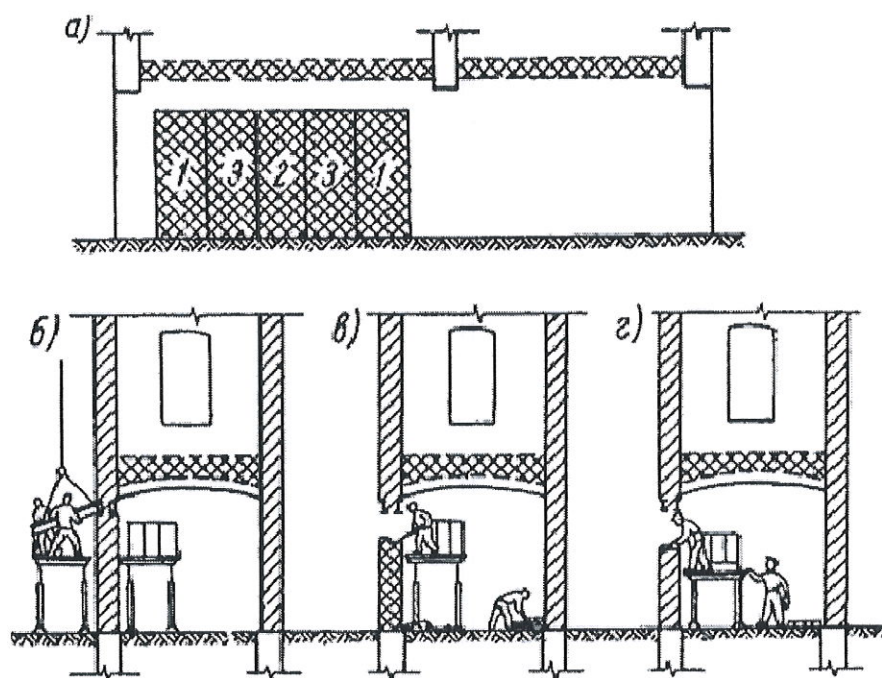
Общая схема организации работ по перекладке участка стены с сохранением вышележащей кладки
